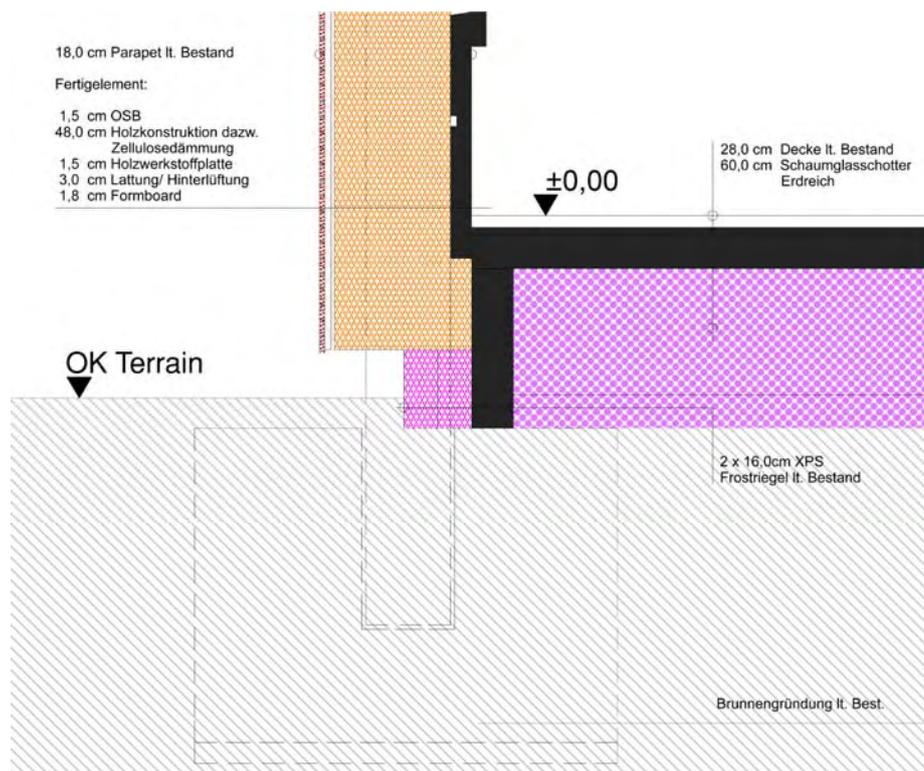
Detailschnitt Sockelanschluss Boden - Wand
